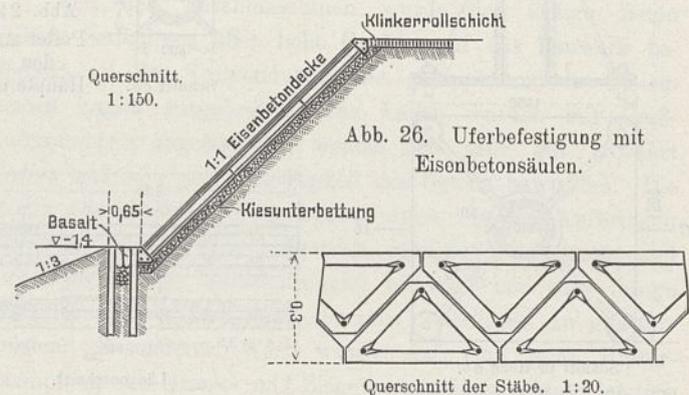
Uferbefestigung mit Eisenbetonsäulen.
